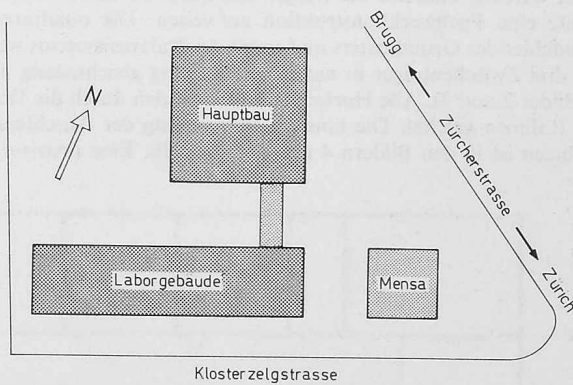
HTL Brugg-Windisch, Lageplan 1:3000
